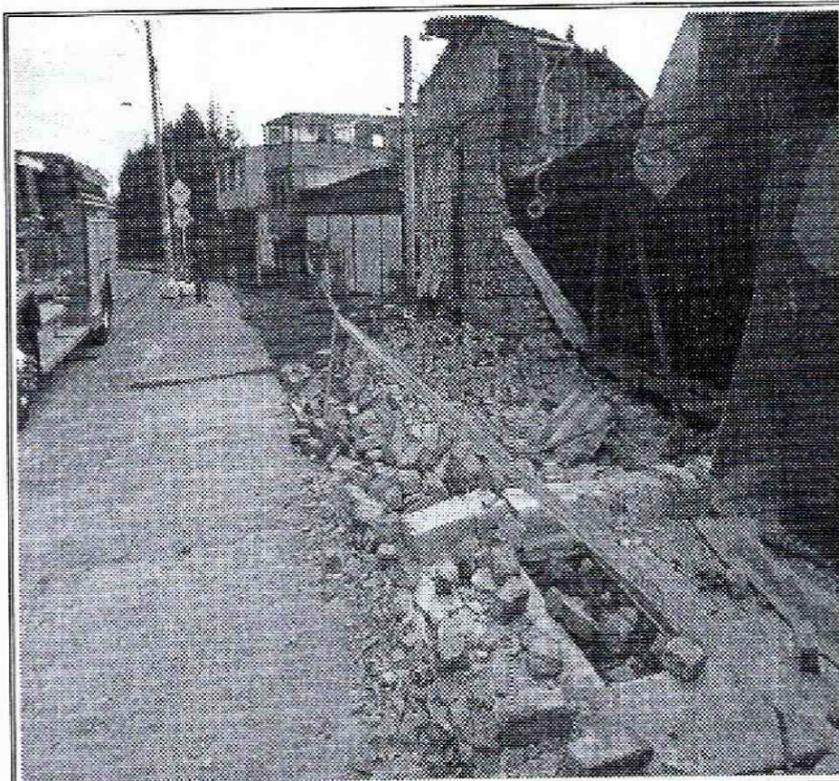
Vista frontal del predio de la Carrera 1 No. 31 - 18
